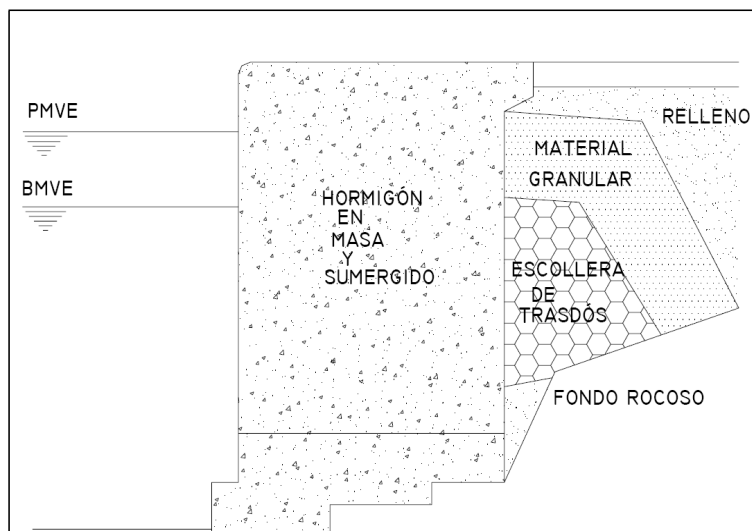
Sección tipo de un muelle con macizo ejecutado in situ
